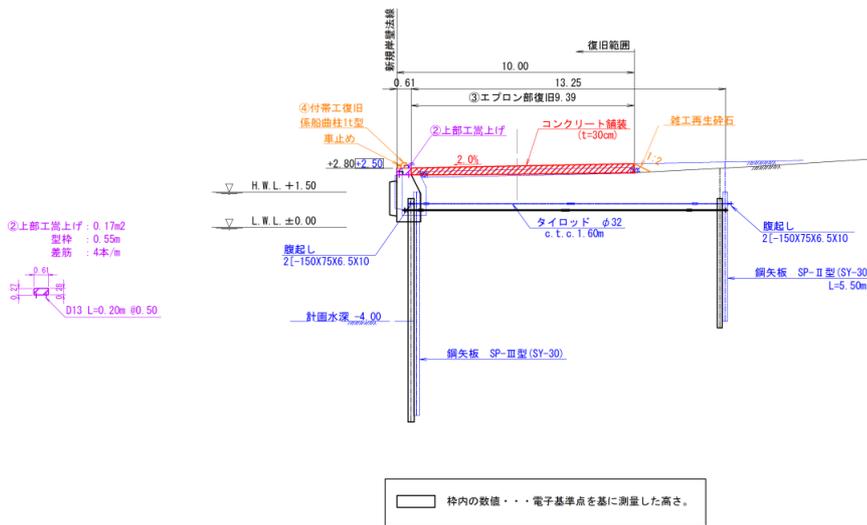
No.14 日立港区_第5埠頭地区第1船だまりの断面図(復旧後)
